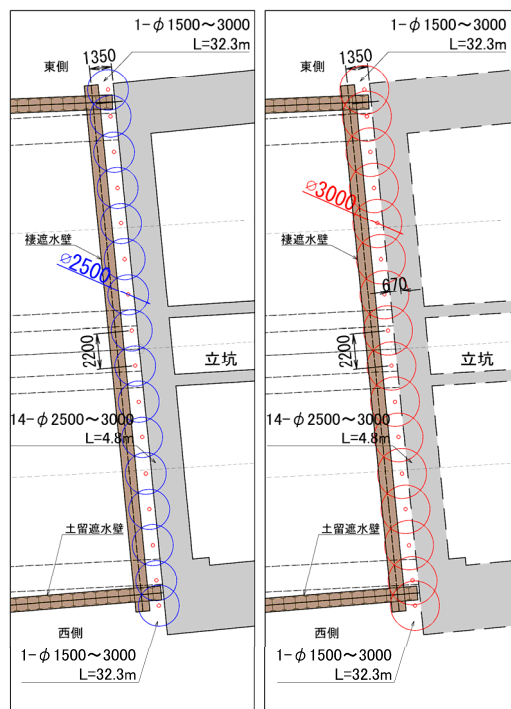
平面図 (左：中間土層断面，右：Tsm 層断面)
